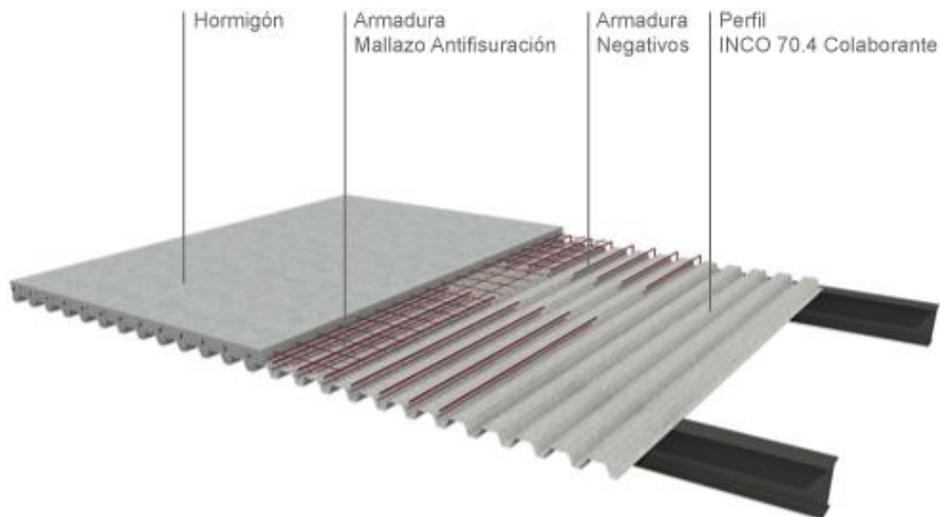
11 Forjado colaborante. Fuente: [Incoperfil, 2019]
